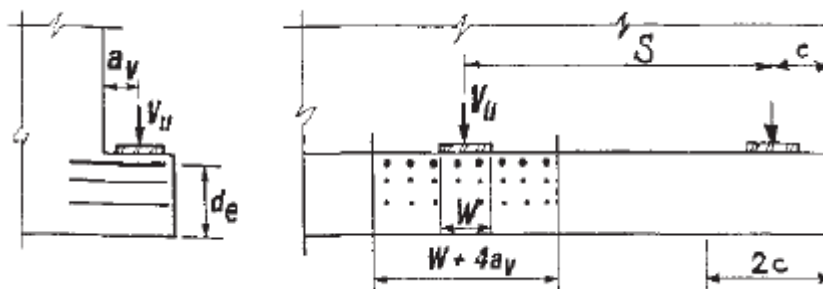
Diseño para corte de Vigas Repisa
